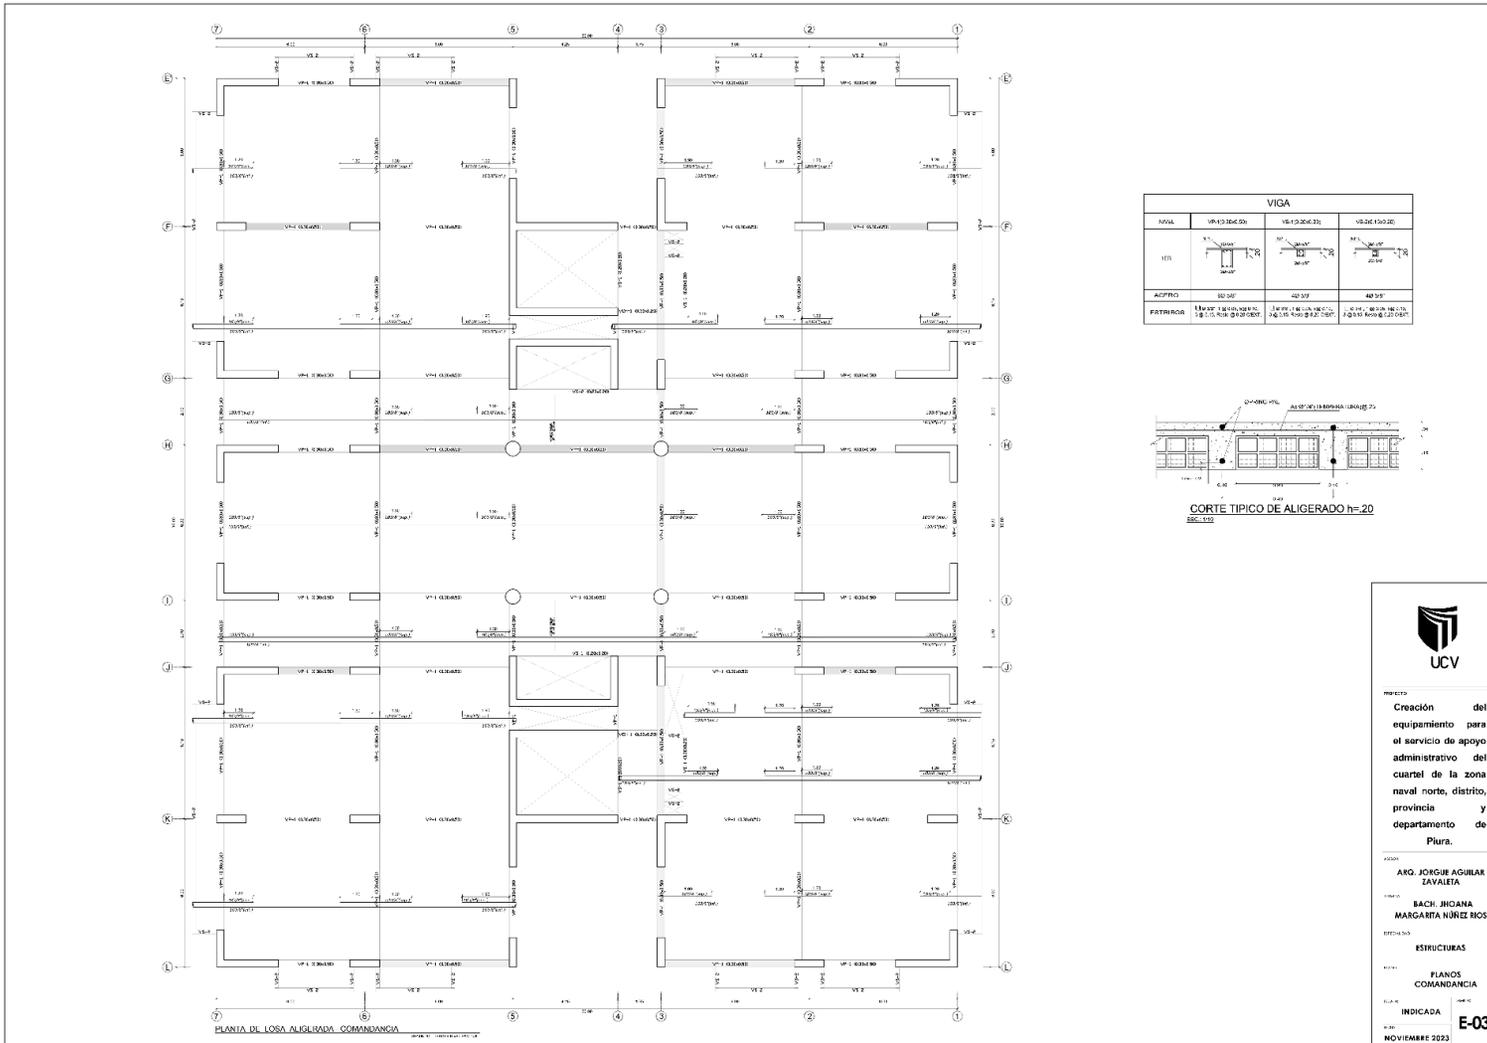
Plano de Losas y Vigas – Bloque Comandancia Tercer nivel
